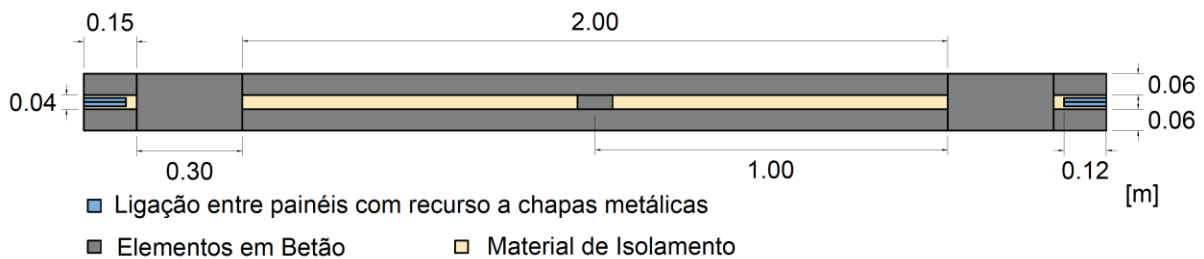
Esquema em planta da solução de painel prefabricado de betão em estudo (dimensões em metros).
